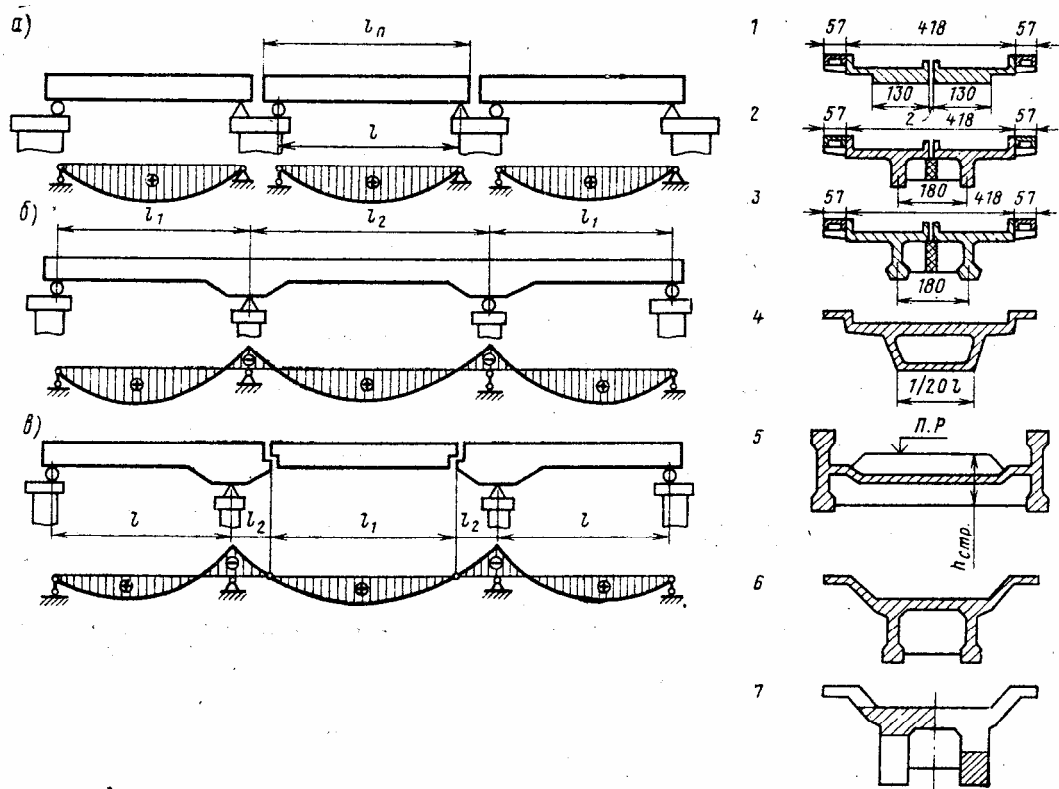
Балочные системы железобетонных пролетных строений с ездой на балласте и эпюры изгибающих моментов в пролетных строениях
